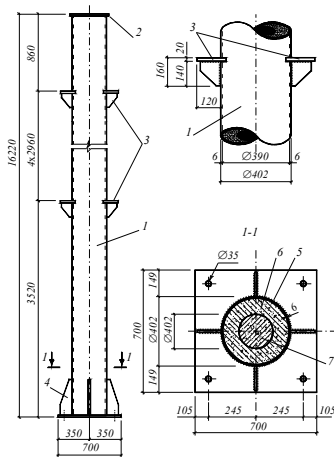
Трубобетонная колонна жилого дома, возводимого методом подъема этажей: 1 - стержень колонны; 2 - оголовок; 3 - опорные консоли; 4 - база; 5 - стальная труба; 6 - центрифугированное бетонное ядро; 7 - бетон заполнения полости ядра
